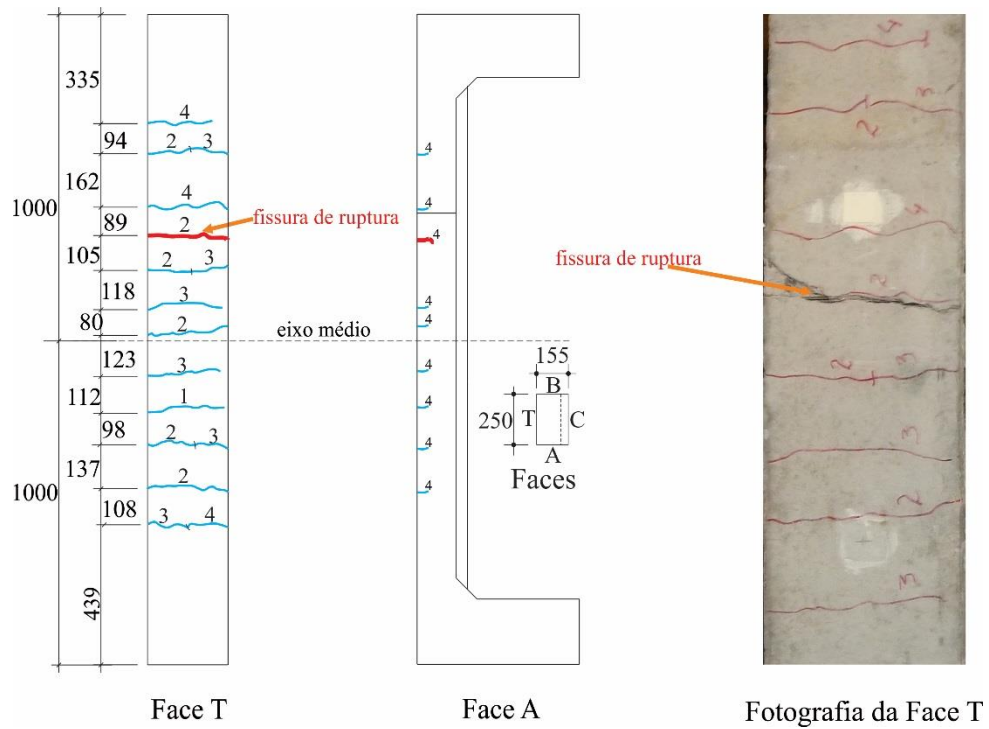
53 - Fissuras nas Faces T e A; Fotografia da face T - pilar PPBA-150-18
